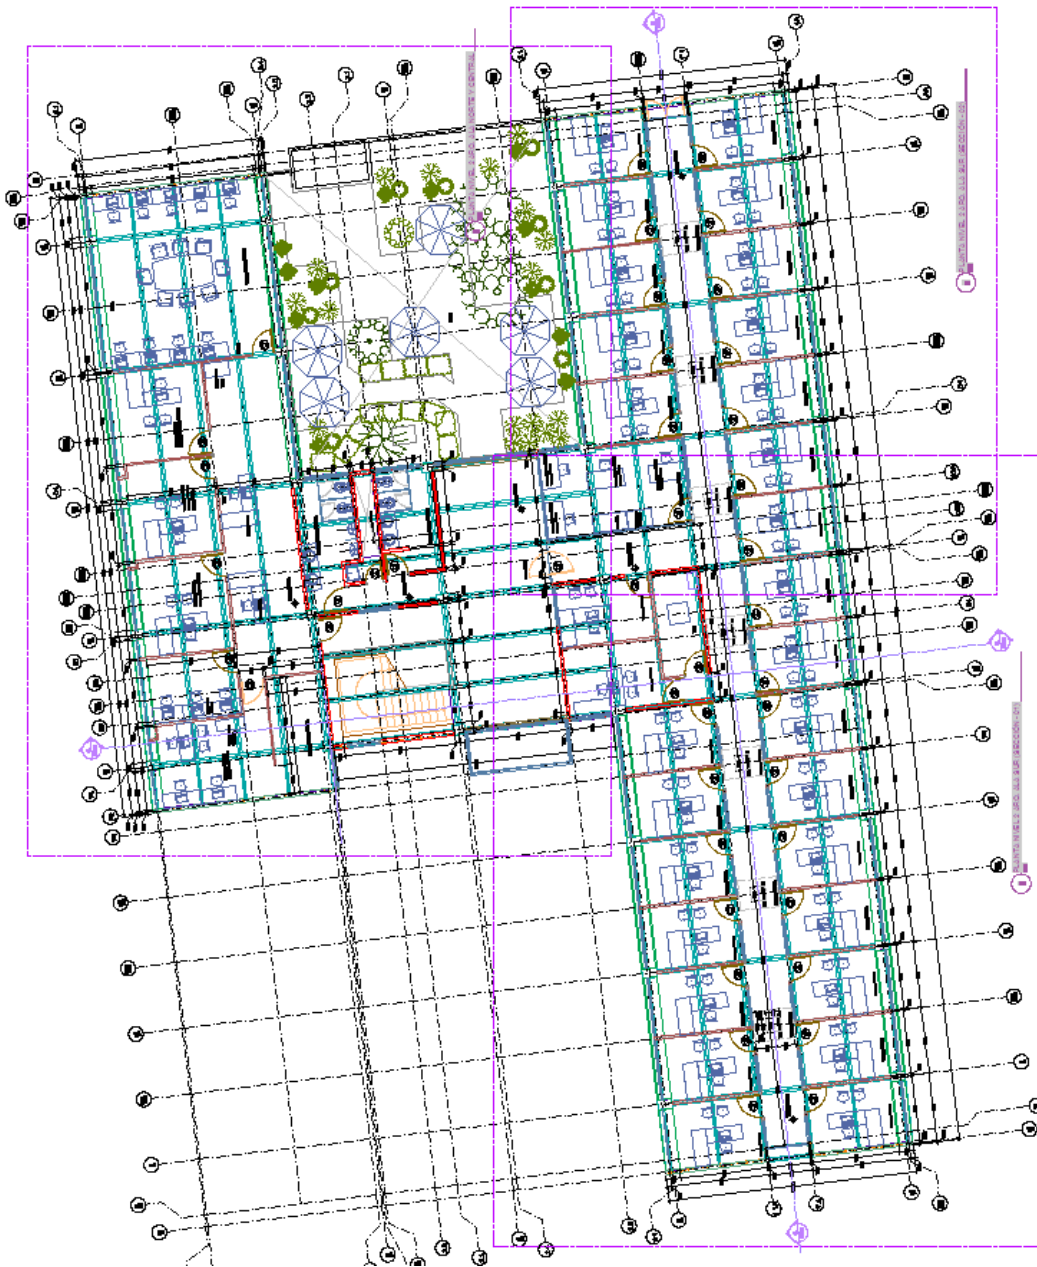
Planta general de la vista arquitectónica del Nivel 2 incluye las proyecciones de las traveses y las vigas metálicas.
